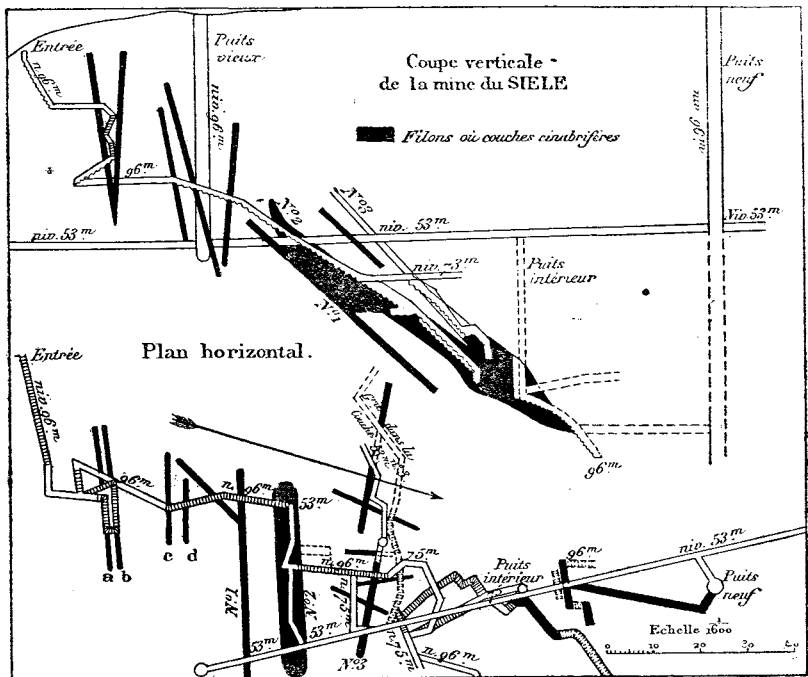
Plan et coupe de la mine de mercure de Siele.
